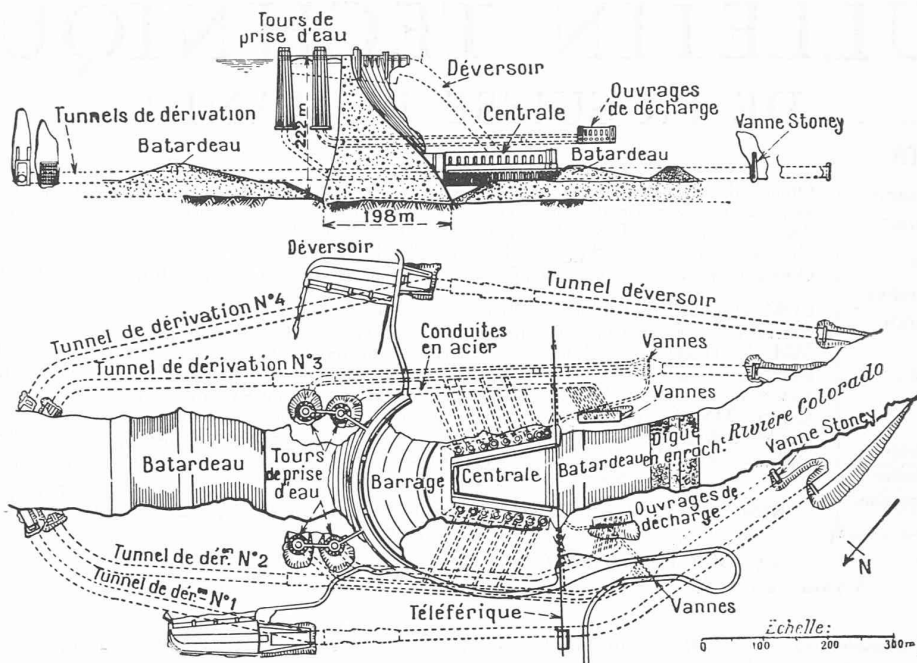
Ensemble des ouvrages, coupe longitudinale et vue en plan.
